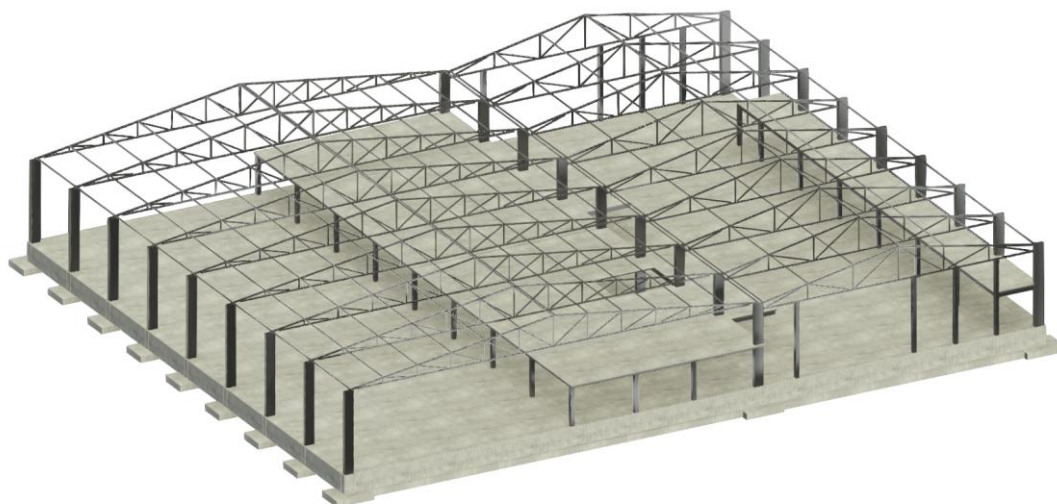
Isometría modelo estructural MantaCar. (AutoBIM, 2025)
